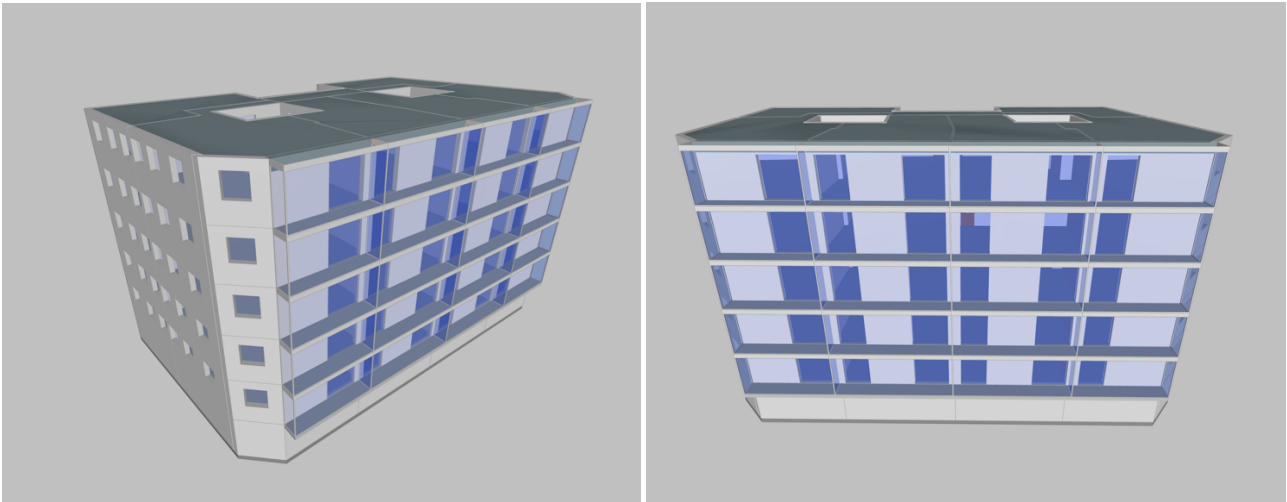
Modelo IFC en CYPETHERM. Perspectiva y Alzado Sur. Vivienda Desideria con invernadero
